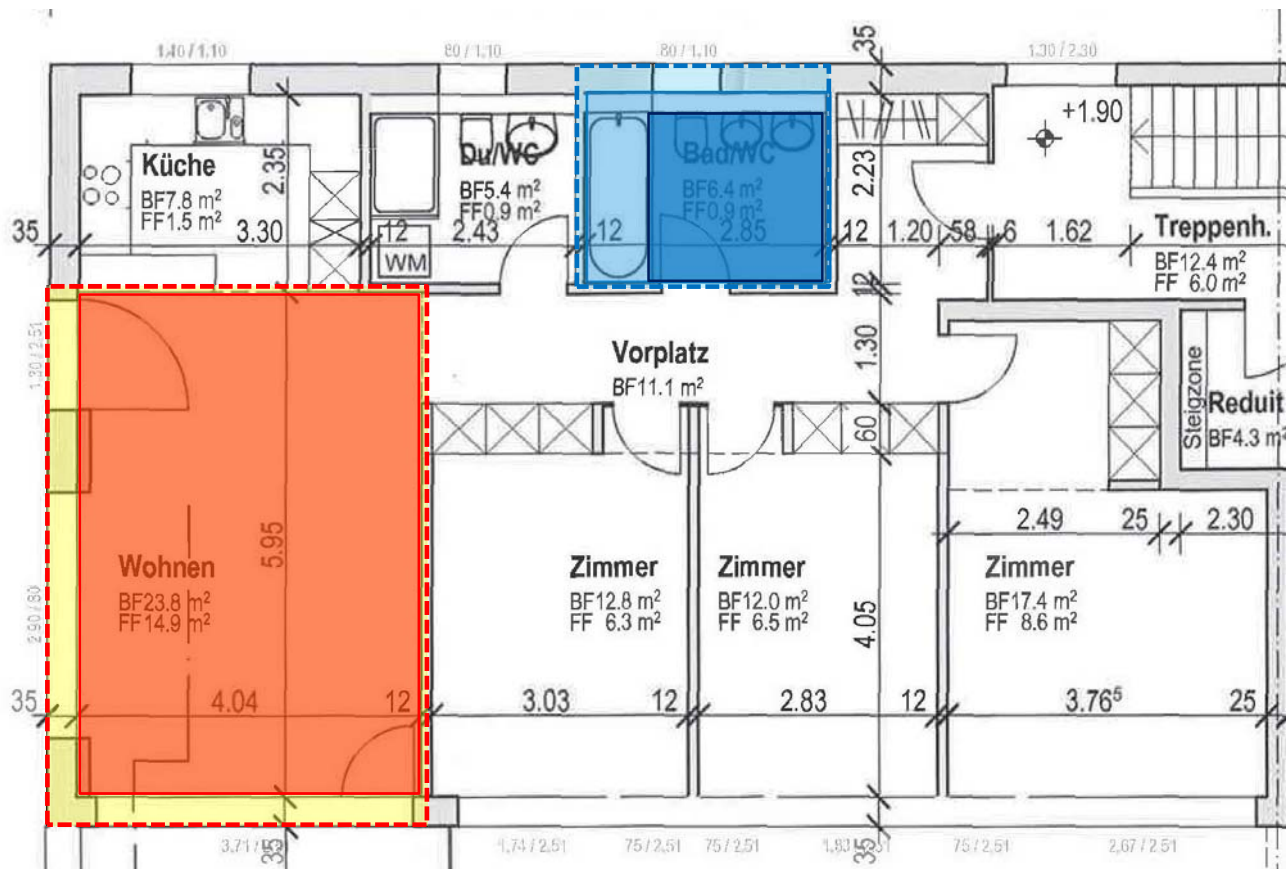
Gebäudebeispiel: Mehrfamilienhaus, Grundriss 4.5-Zimmer-Wohnung im Obergeschoss
